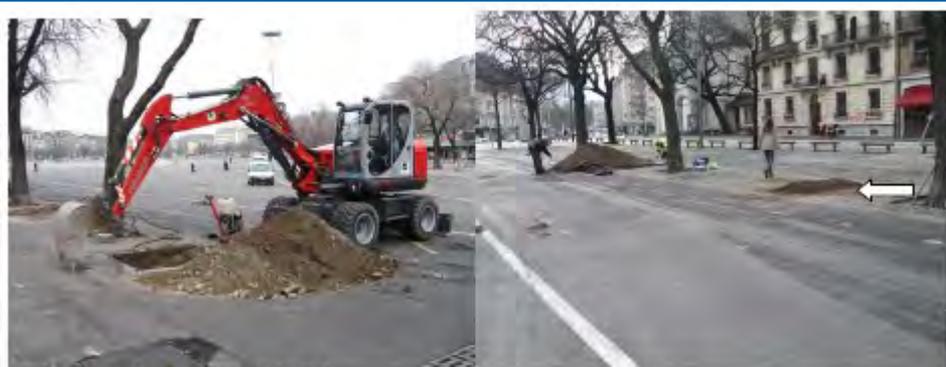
Découpe de l'enduit bitumineux et creuse du profil n° 1
